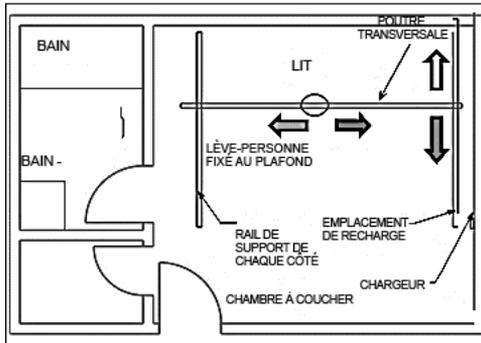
Système Handicare X-Y utilisant une poutre transversale
